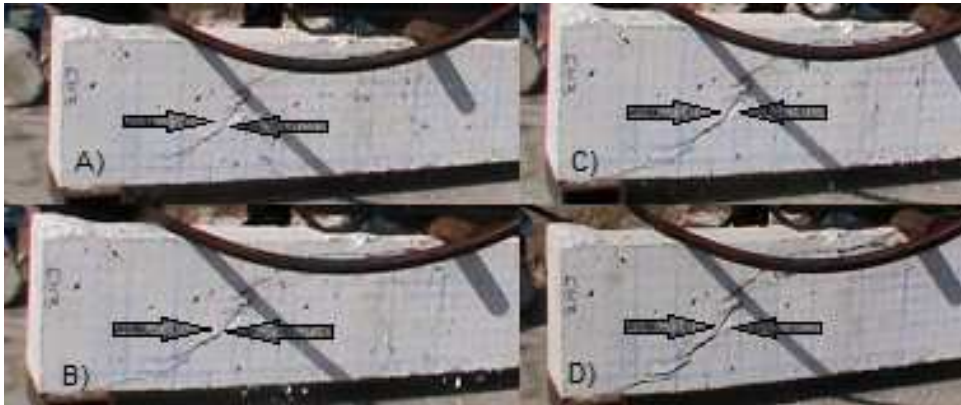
Patrón de grietas de la viga CN3.
